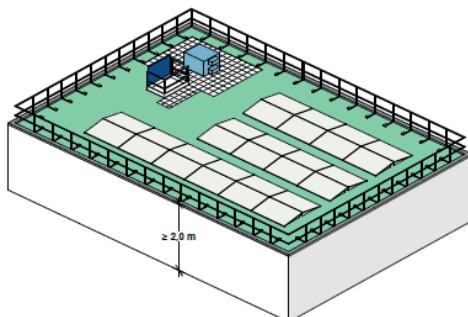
Classe d'équipement 3: protection collective à recommander pour les toits plats auxquels on doit accéder plusieurs fois par an pour de la maintenance ou d'autres travaux
